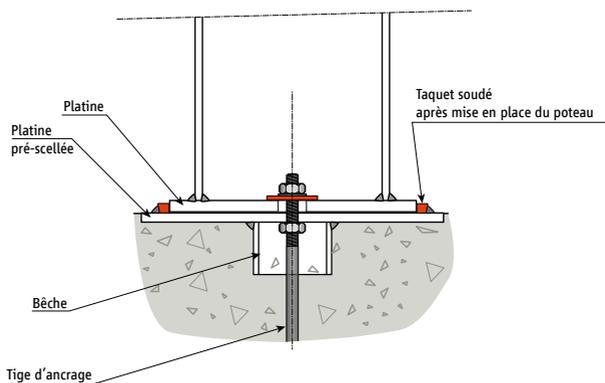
Transfert des efforts horizontaux entre pied de poteau et platine pré-scellée par taquet
